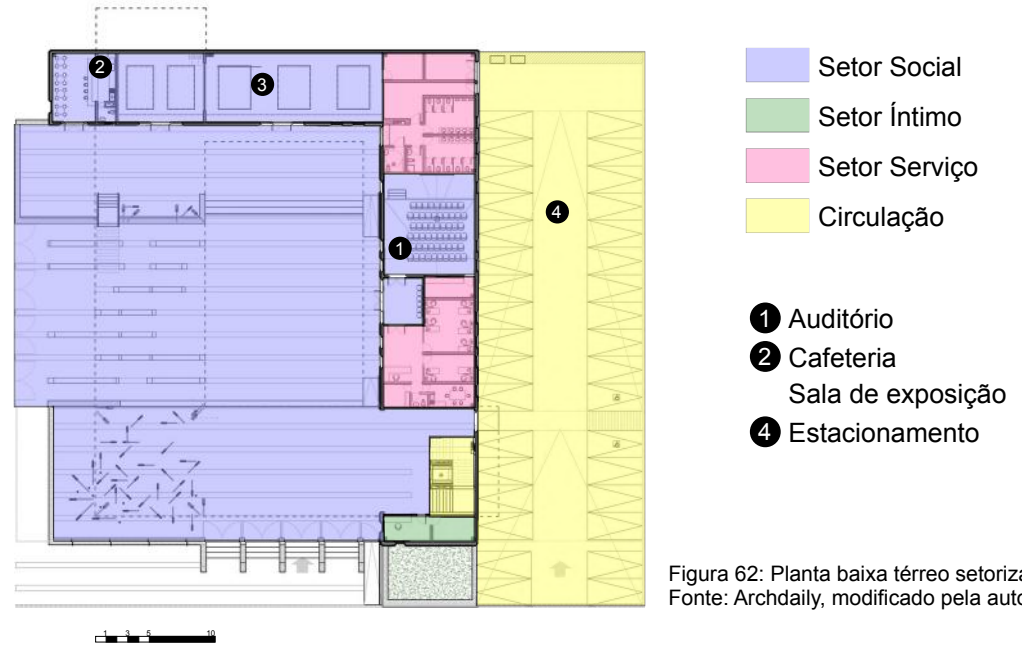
Planta baixa térreo setorizada. Fonte: Archdaily, modificado pela autora.
